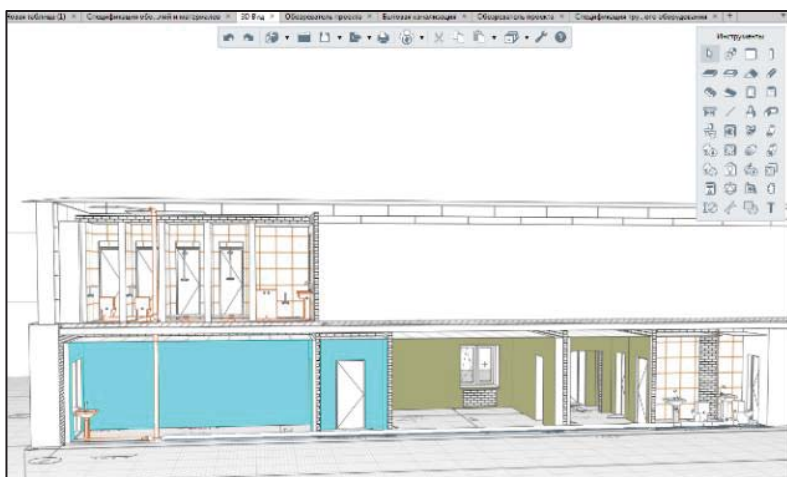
Размещение трубопроводов на 3D-модели здания
